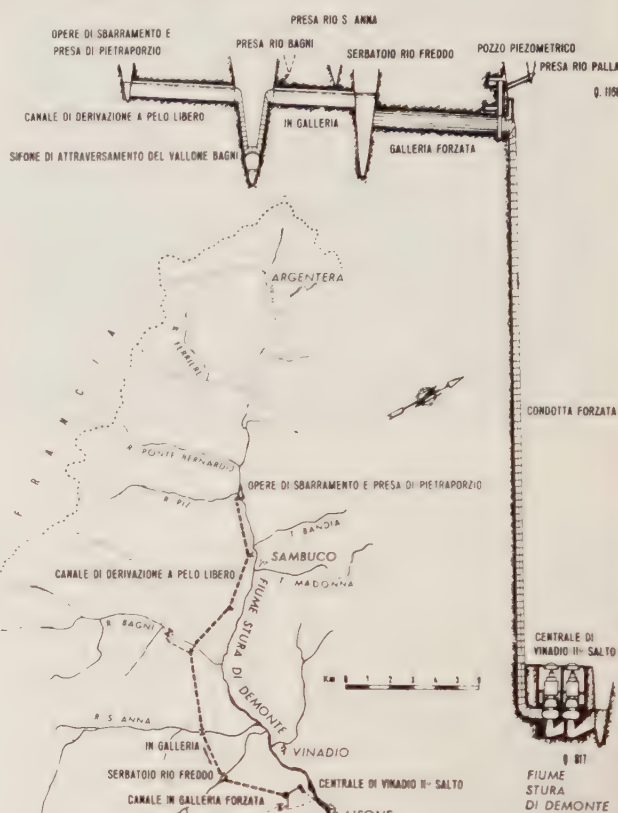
Planimetria e profilo generale degli impianti sullo Stura di Demonte.
